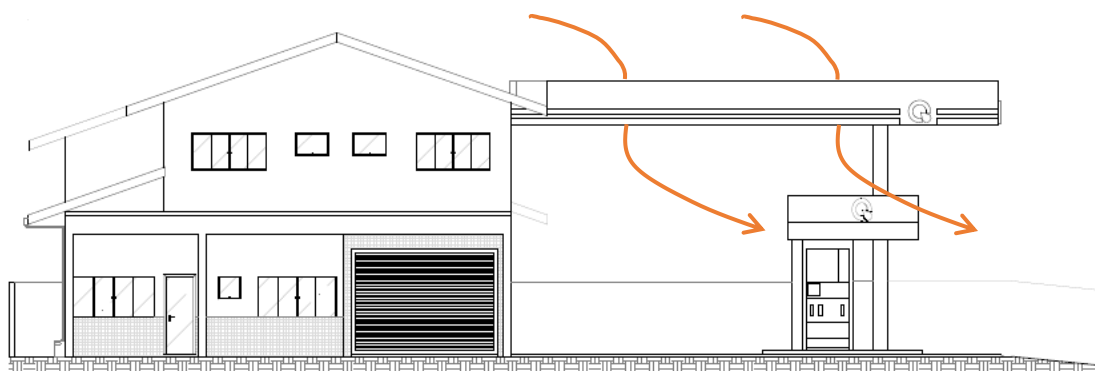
Fachada do imóvel, com detalhe de passagem de ventilação
